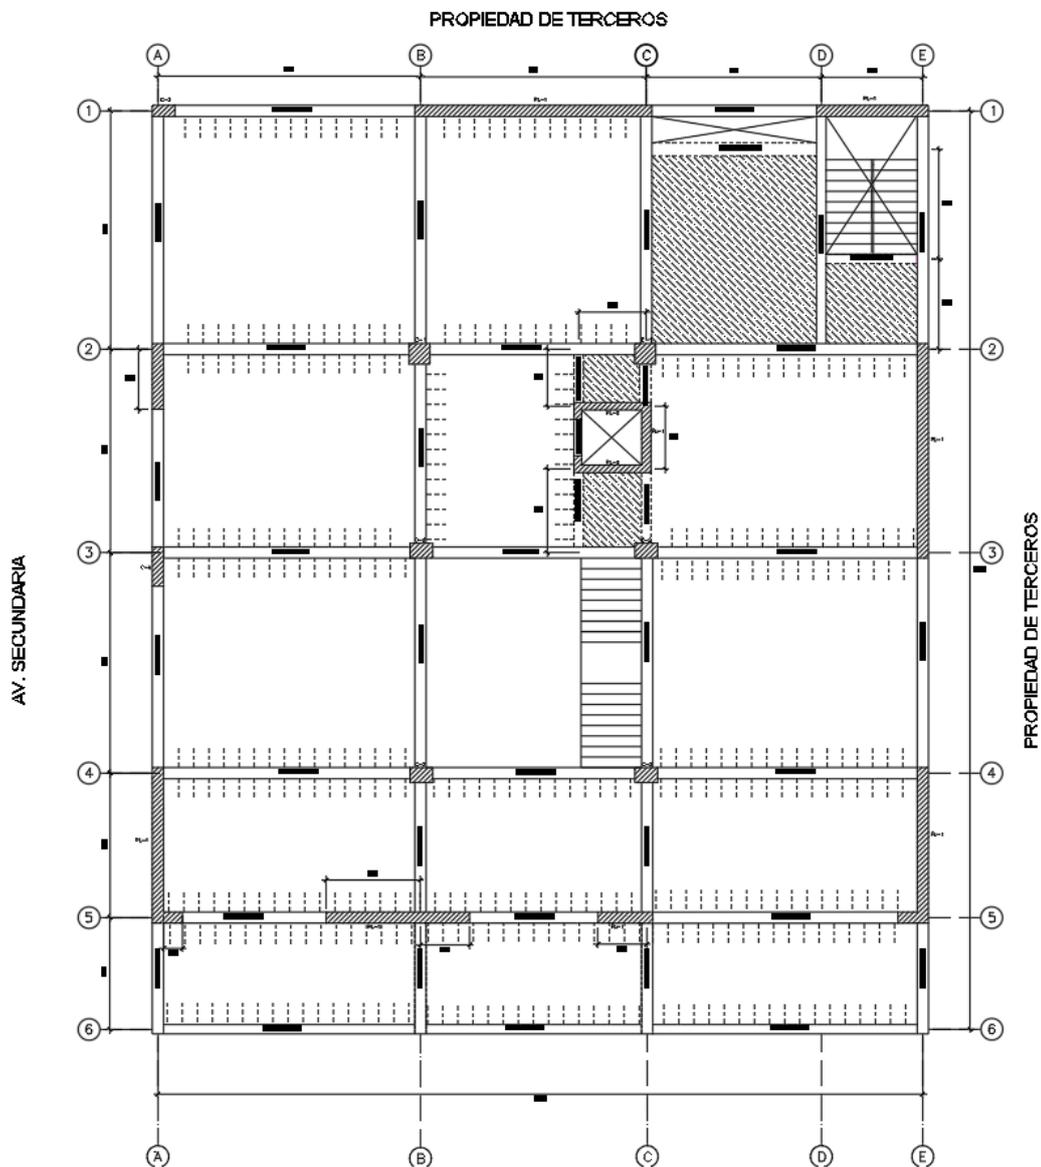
Predimensionamiento y Estructuración de la Edificación de 10 niveles
